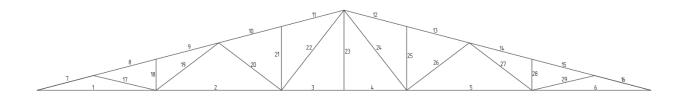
Конечно-элементная модель стропильной фермы
